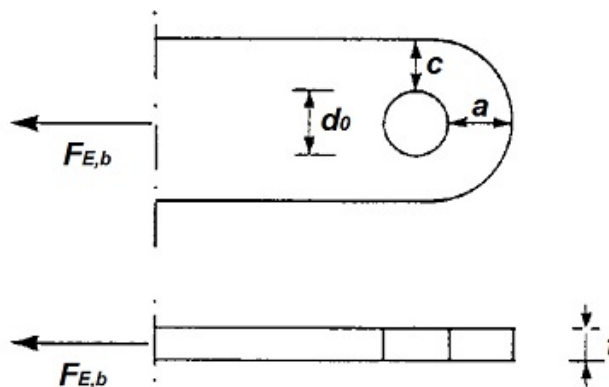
Geometría de la pieza que enlaza el pasador (Fuente: ingemecanica.com)
